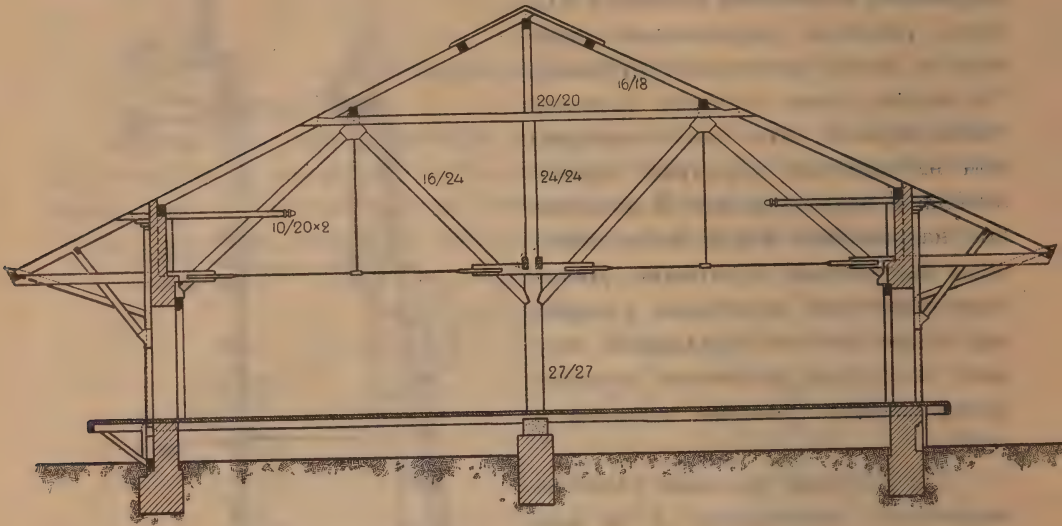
несколько видоизмененная конструкция типа перекрытия, указанного на фиг. 251. В этом случае вместо деревянных поперечных схваток, в пролетах применены железные струны с гайками для подтягивания. Так как вместо бабки применено также круглое железо, то врубка подкосов шпренгеля заменена
